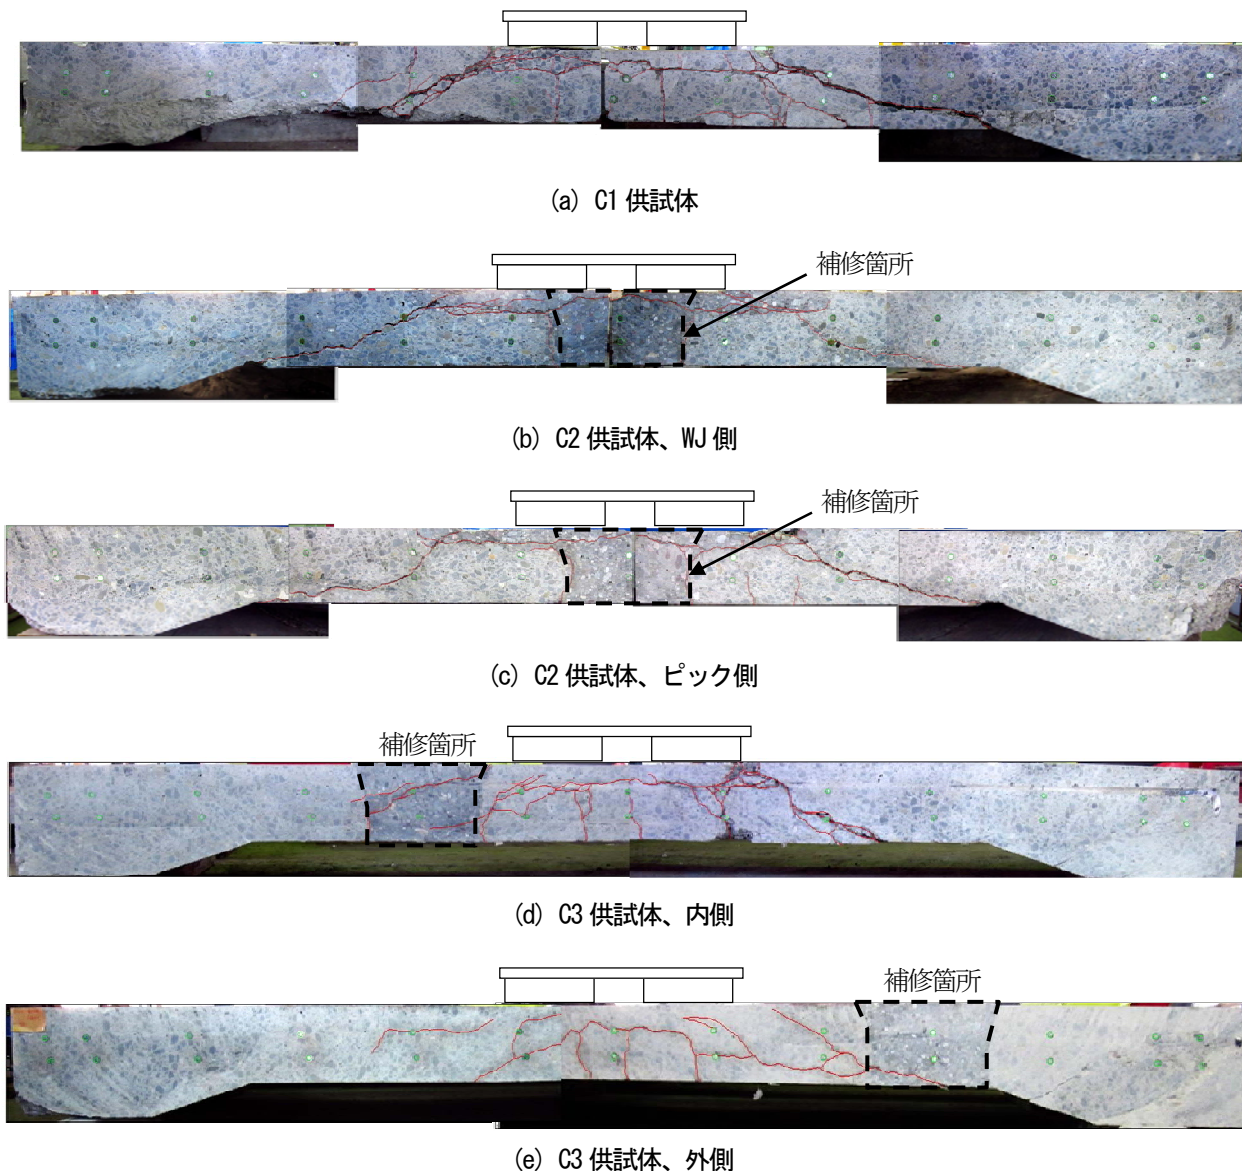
切断面のひび割れ状況（走行直角方向）
